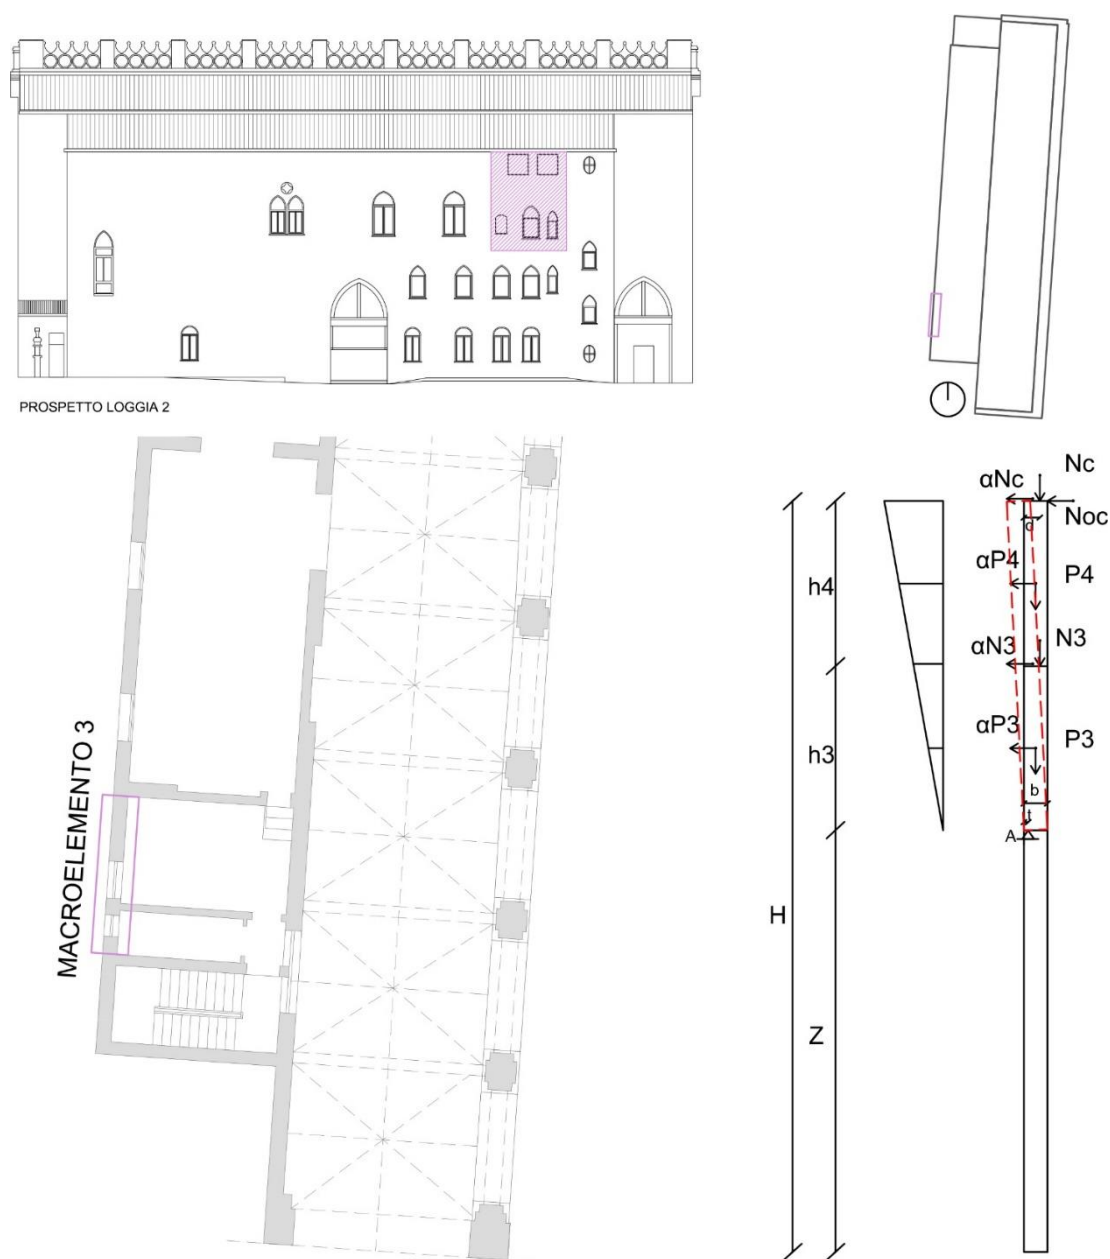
Individuazione del macroelemento in prospetto e pianta
